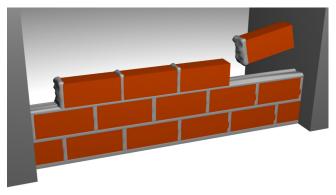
Aparejo en Panderete Fuentes: Elaboración propia
